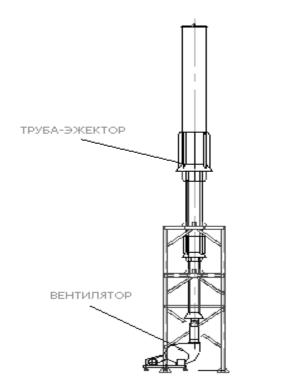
Компоновка и общий вид трубы-эжектора
